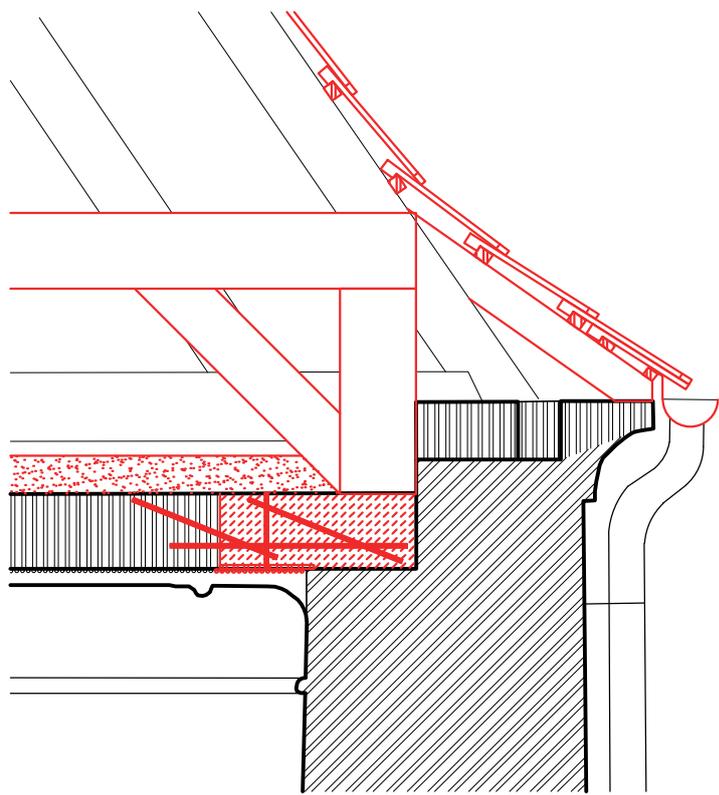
Vorschlag 3 zur Sanierung der Decke mit Polymerbeton und neuer Konstruktion zur Abhängung, Schnitt 1.
